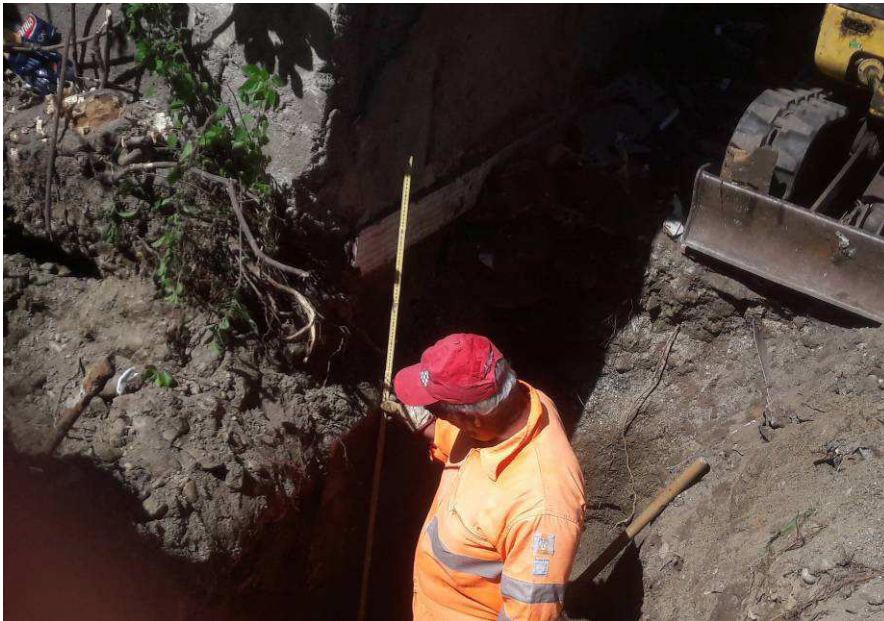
Indagine SF2 (saggio in fondazione) del Blocco B: è stata rilevata una fondazione in cls di altezza pari a 140 cm.
